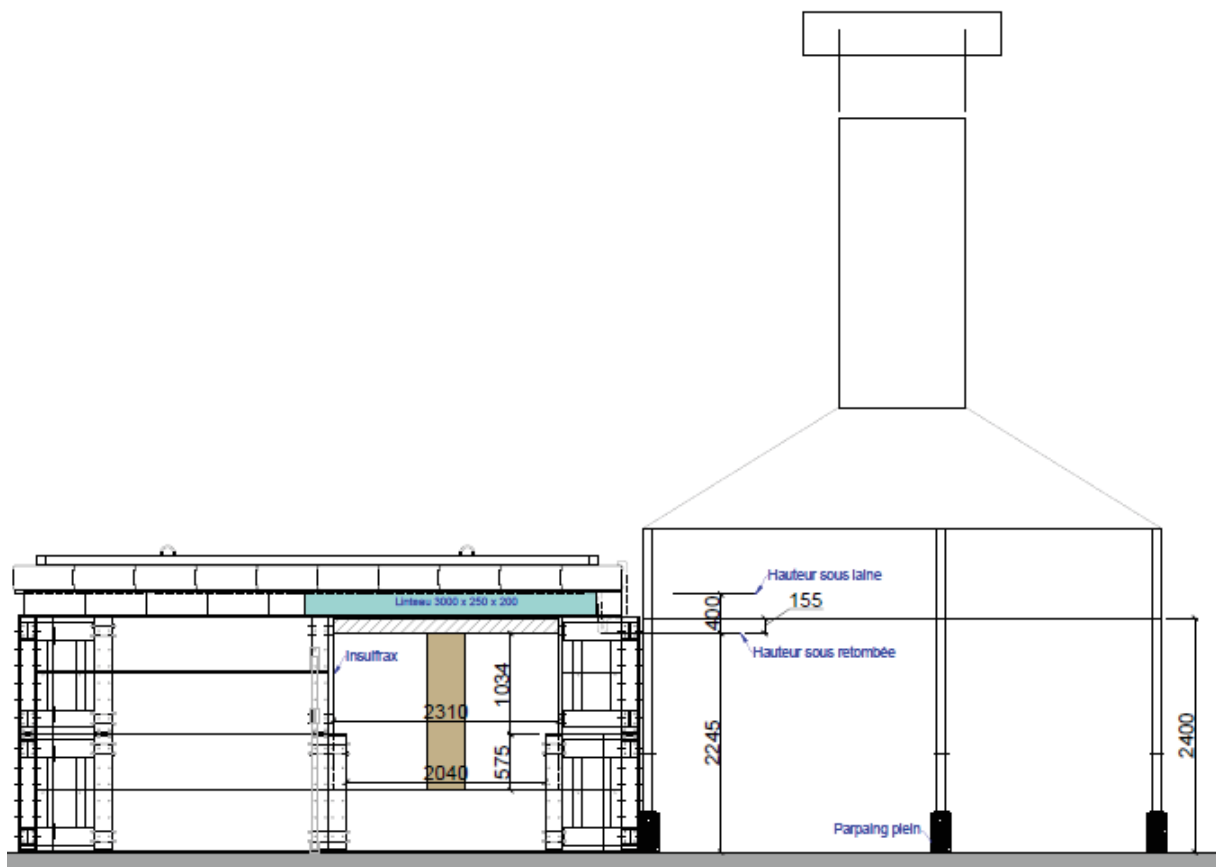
Élévation Ouest de la cellule d'essai pour l'essai 3 (poteau/poutres LC)
